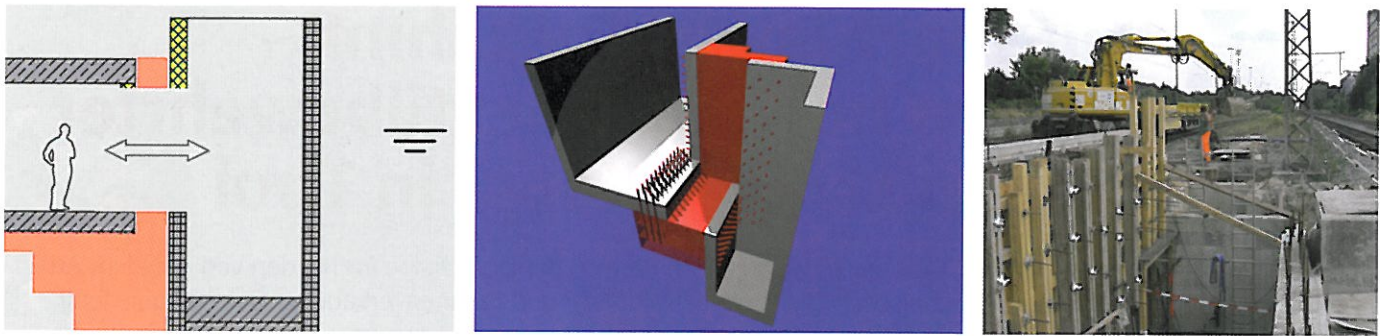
Ebene (links) und räumliche (Mitte) Darstellung des Anschlusses Betonrohr an Bestandsunterführung mit Injektionen sowie Foto (rechts) des Baustands in Königslutter vor der Anbindung des ersten Fahrstuhlschachts an die Fußgängerunterführung zwischen den Bahngleisen.
